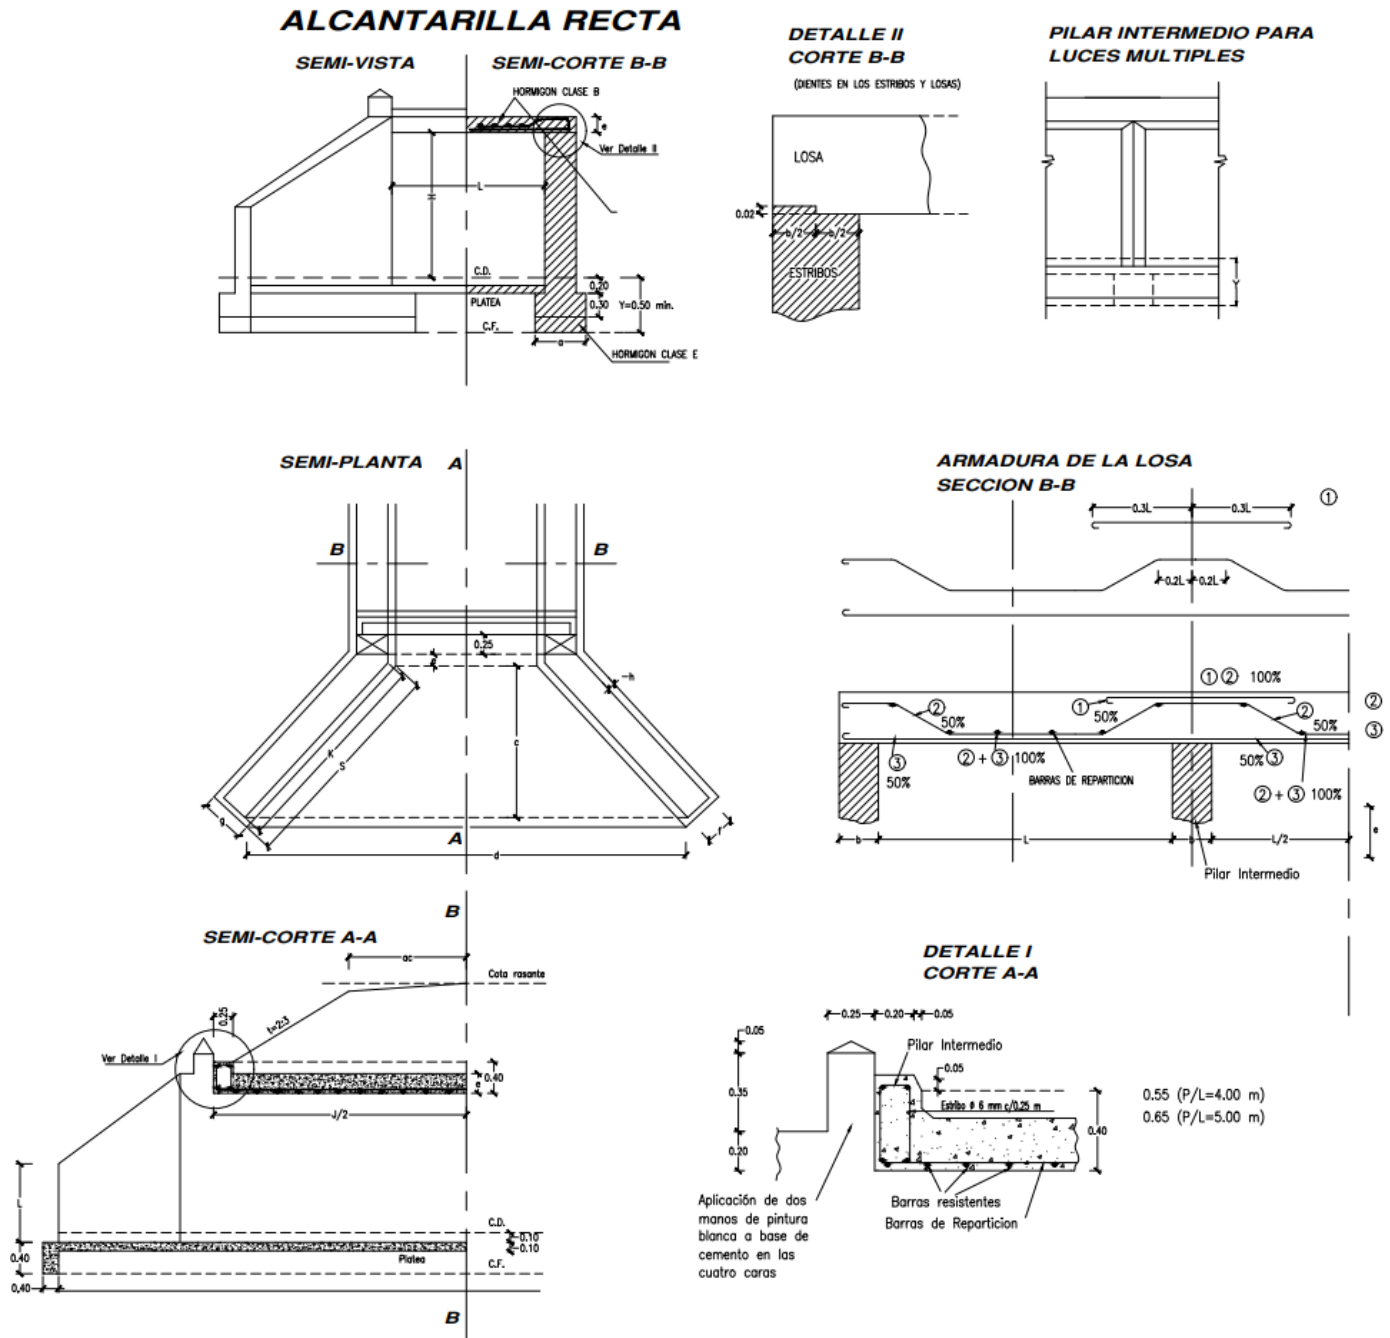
Plano detalles de alcantarilla tipo O- 41211
